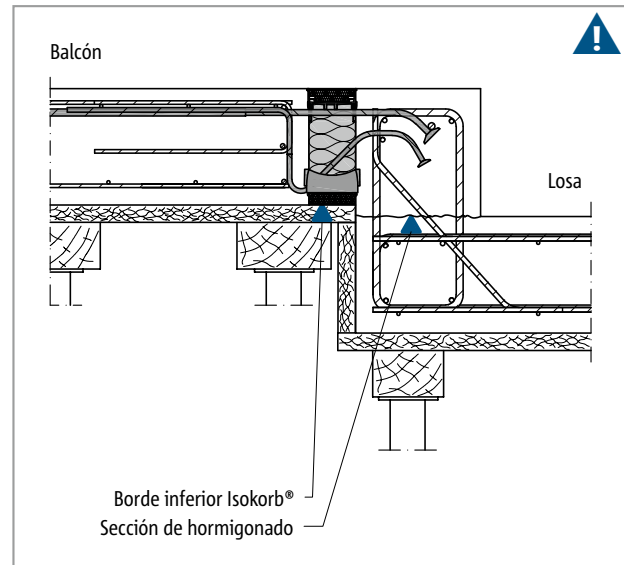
Schöck Isokorb® T tipo K-O: Balcón de hormigón in situ con desplazamiento de altura hacia arriba
